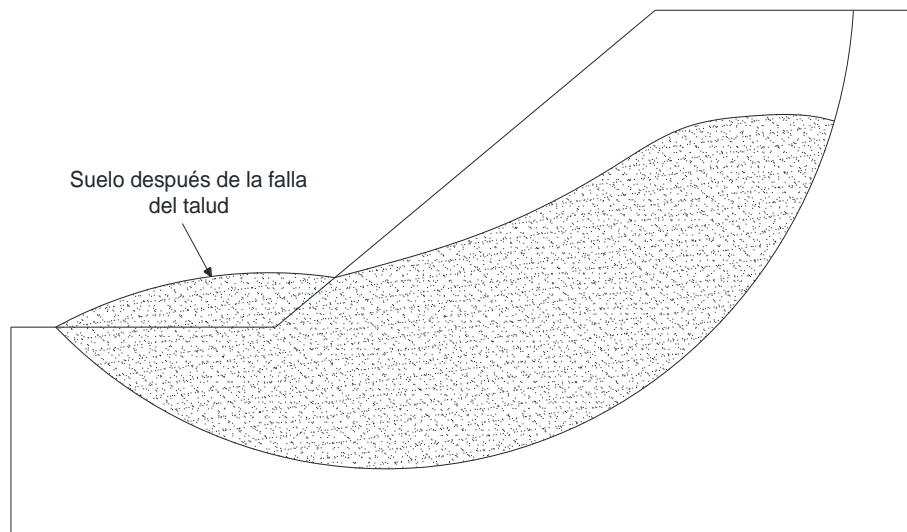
Falla en un talud. Fuente: Fundamentos de ingeniería geotécnica, Braja M. Das
